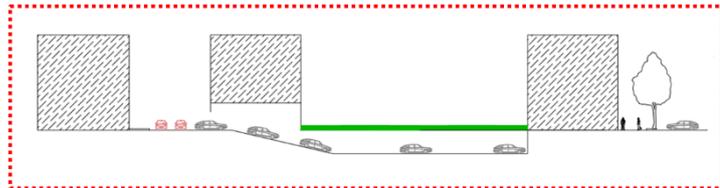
coupe sur le parking sous-sol (source : auteur)
